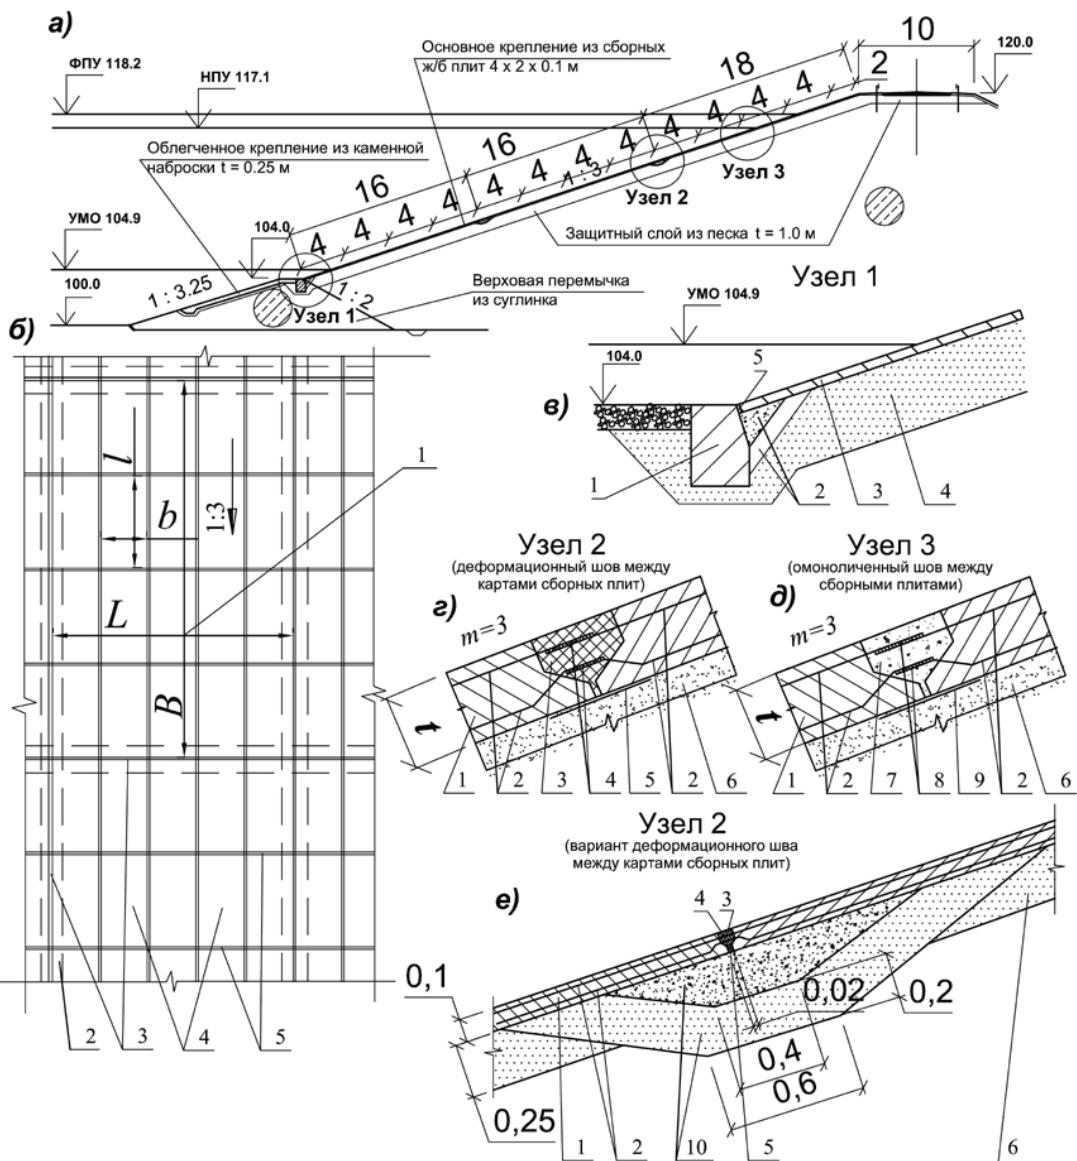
Пример крепления верхового откоса из сборных железобетонных плит [13]: а – разрез по верховому откосу; б – раскладка плит на верховом откосе, 1 – карта из сборных плит; 2 – ленточные фильтры под деформационными швами 3 между картами 1; 4 – сборные плиты, омоноличиваемые между собой в швах 5 внутри карты 1; в – упор из сборного или монолитного бетона, 1 – бетонный блок; 2 – слои обратного фильтра; 3 – плита крепления; 4 – выравнивающая подготовка или защитный слой из песчано-гравийных грунтов; 5 – доска, пропитанная битумом; г – вариант деформационного шва между картами из сборных плит, 1 – сборные плиты; 2 – рабочая арматура; 3 – битумная мастика; 4 – крутка выпусксов арматуры вязальной проволокой; 5 – фильтр из геотекстиля; 6 – выравнивающая подготовка или защитный слой из песчано-гравийных грунтов; д – вариант омоноличенного шва между картами из сборных плит, 7 – бетон омоноличивания; 8 – сварка выпусксов арматуры; 9 – лист рубероида; остальные обозначения те же, что и на рисунке г; е – вариант деформационного шва между картами из сборных плит, 1 – сборные плиты; 2 – рабочая арматура; 3 – битумная мастика; 8 – скрутка выпусксов арматуры вязальной проволокой; 5 – доска, пропитанная битумом; 6 – выравнивающая подготовка или защитный слой из песчано-гравийных грунтов; 10 – слои обратного фильтра
